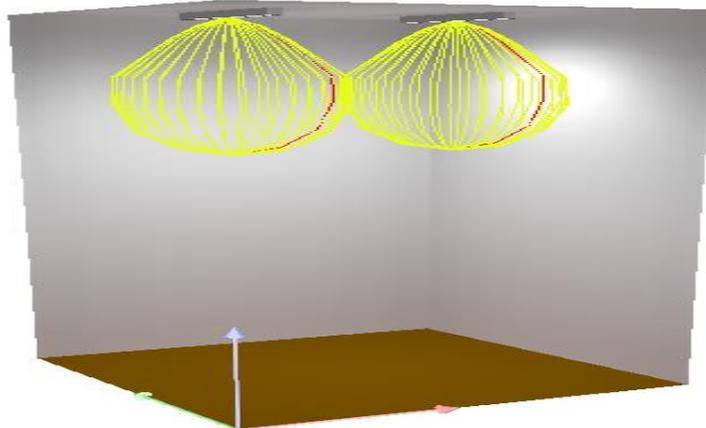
Sebaran Cahaya pada Ruang JPTK / Ruang Kerja
